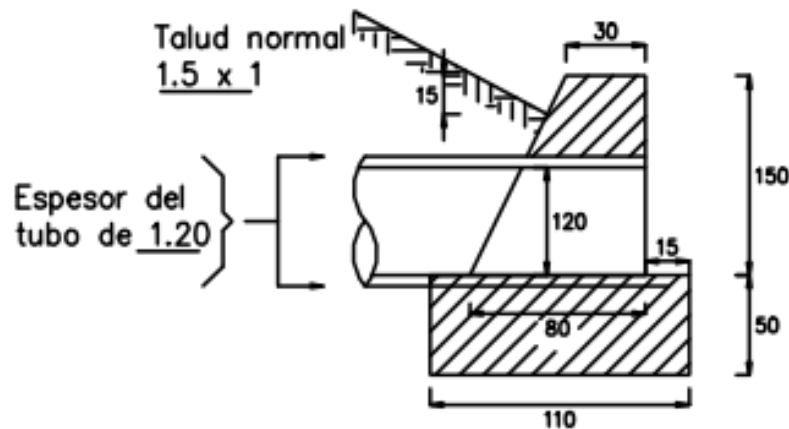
Vista en corte horizontal de las obras de drenaje de una línea de tubería de concreto.
